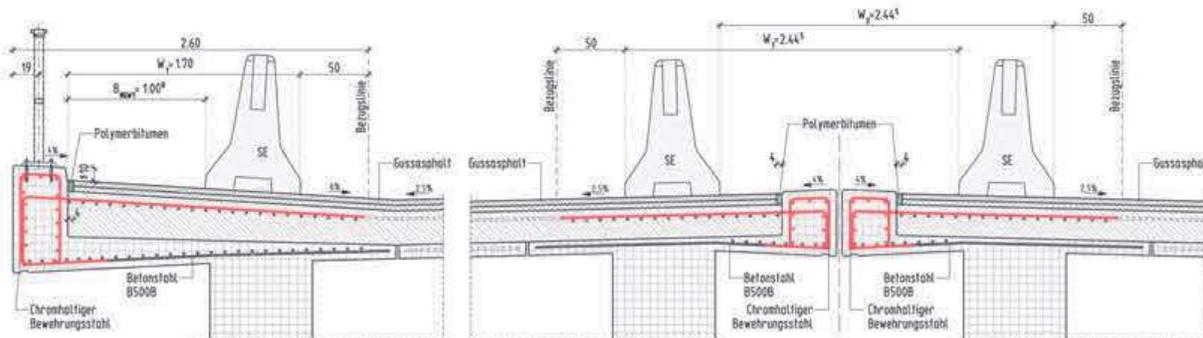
Details Randausbildung (Außenkappe und Mittelkappe)
